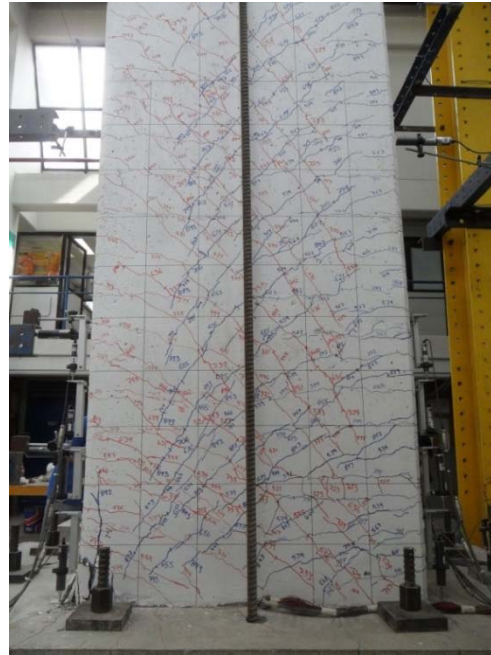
Primeras grietas de cortante de espécimen PH3
